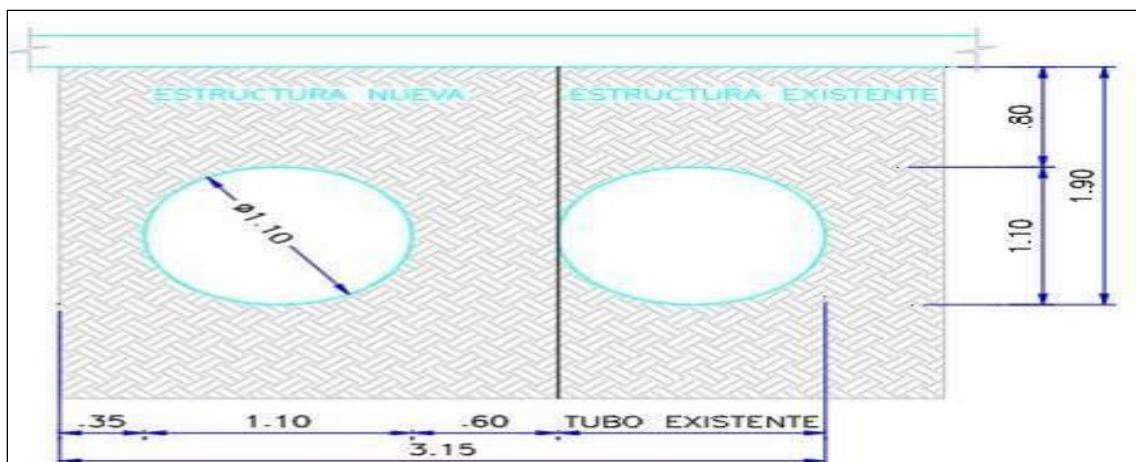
Vista frontal o corte B-B de la obra existente en el PR 84+040
